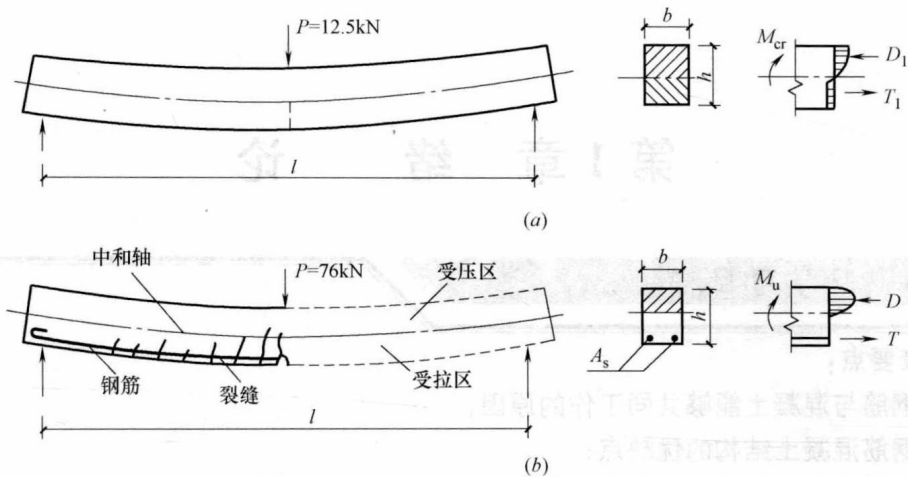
混凝土及钢筋混凝土筒支梁的承载力
